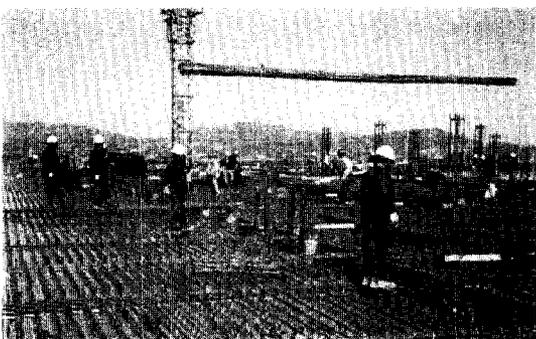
Step 3 : Plenum slab beam & Ferrodeck
